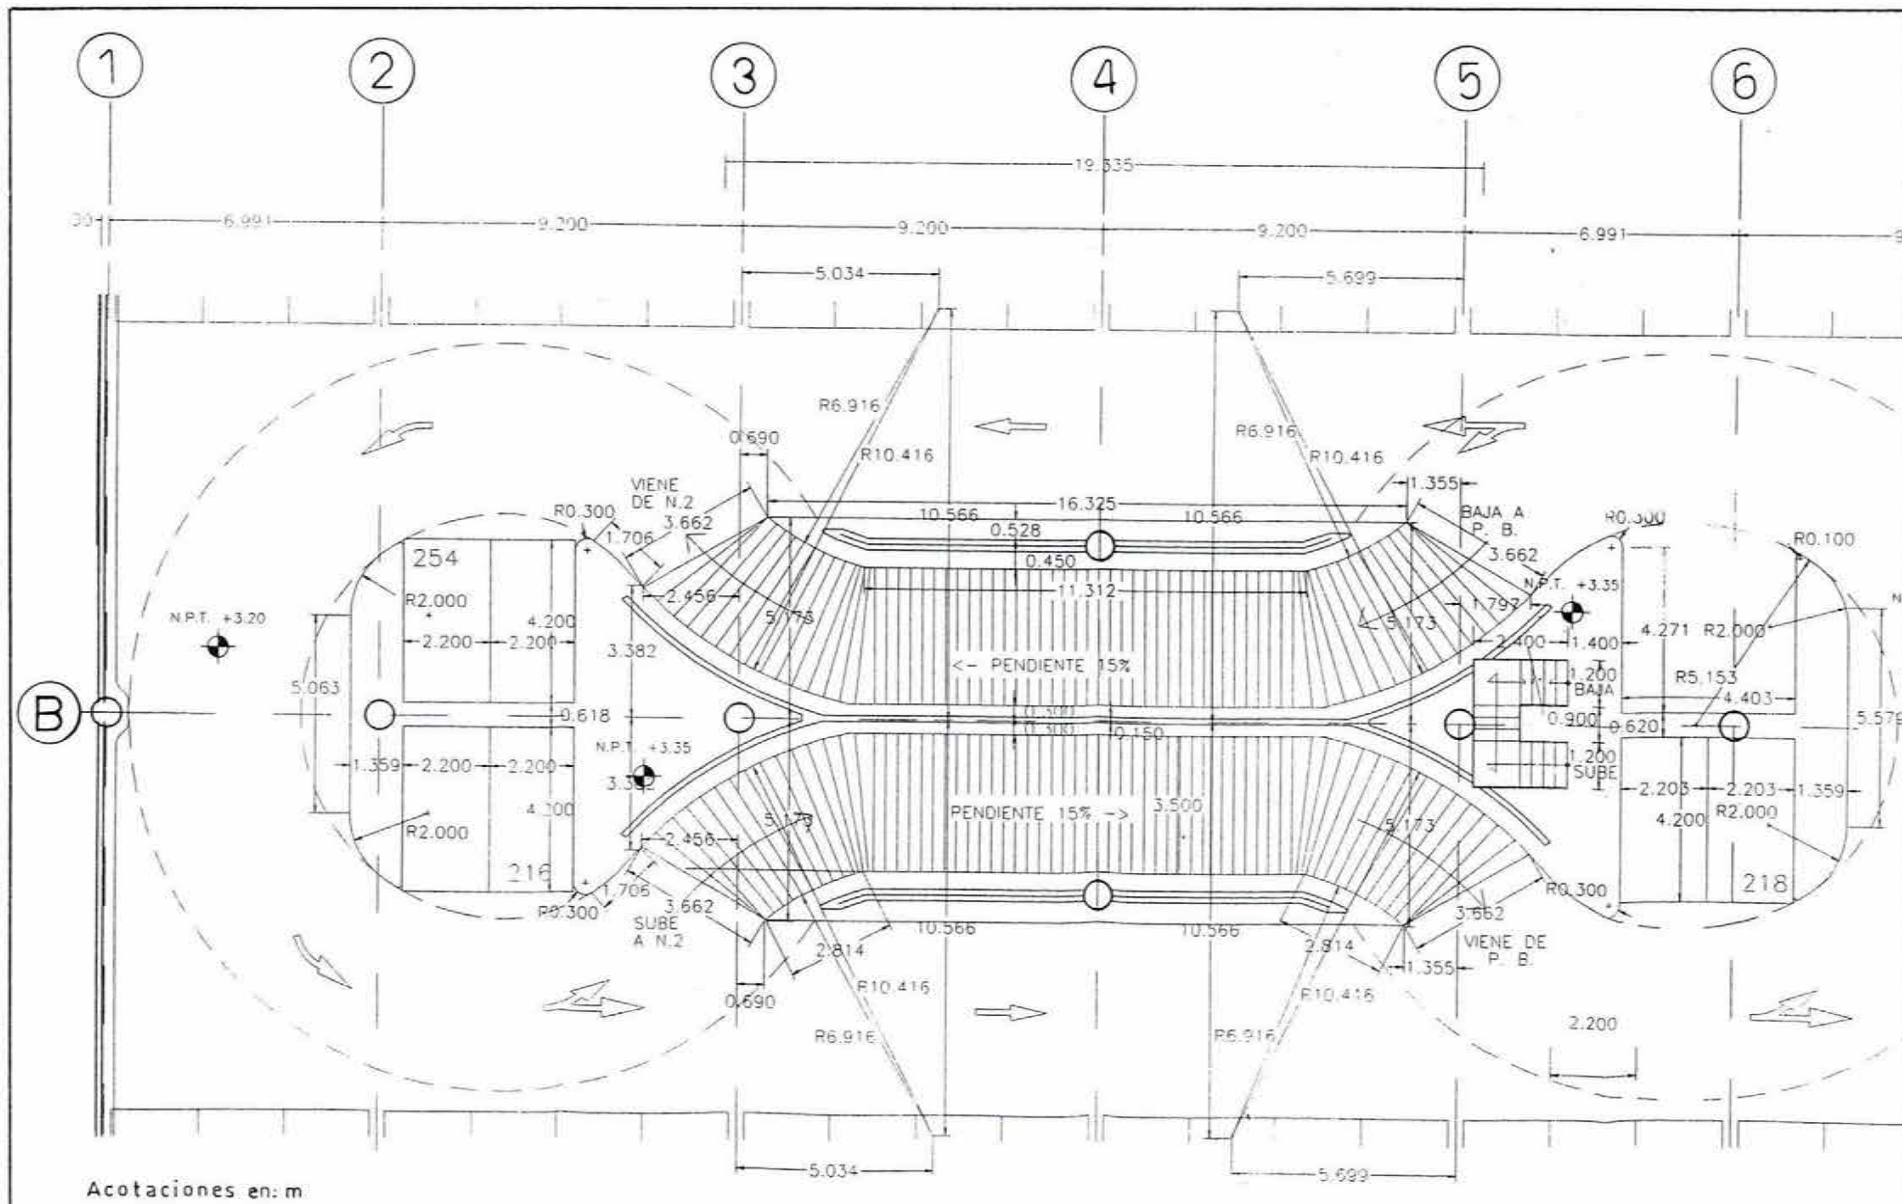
PLANTA DE RAMPA NIV. 1 A NIV. 3
